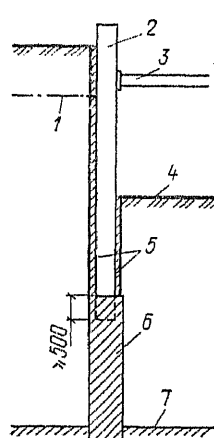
Конструкция стен в грунте смешанного типа
